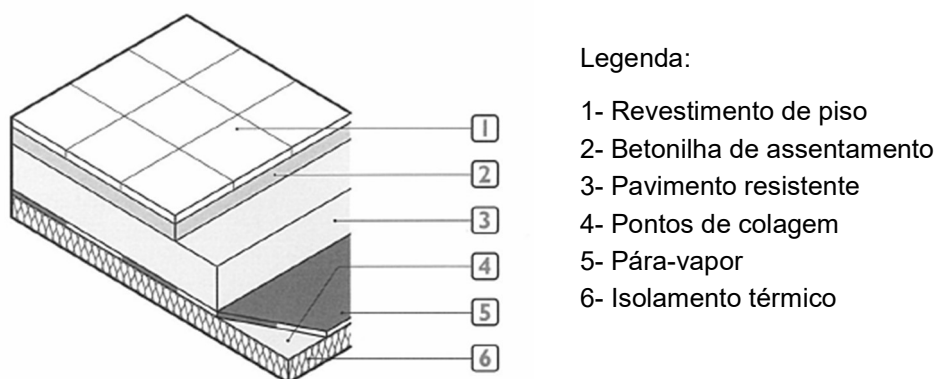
Pavimento sobre espaço exterior ou não aquecido: Isolamento térmico inferior [103]
